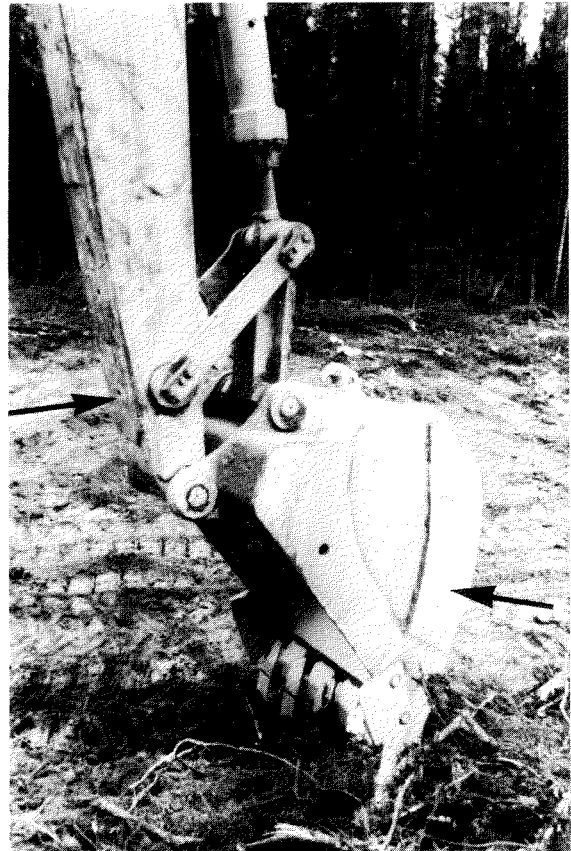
Plaques de friction additionnelles sur le bras d'excavation et le godet.
